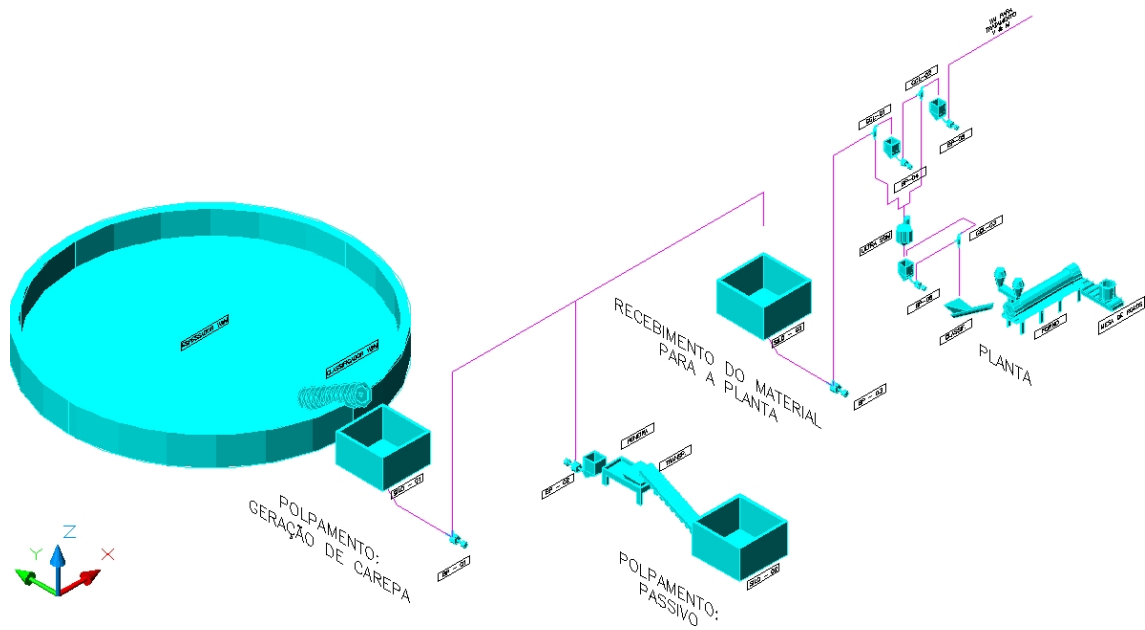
Projeto de planta industrial para instalação imediata na V&M Tubes.
